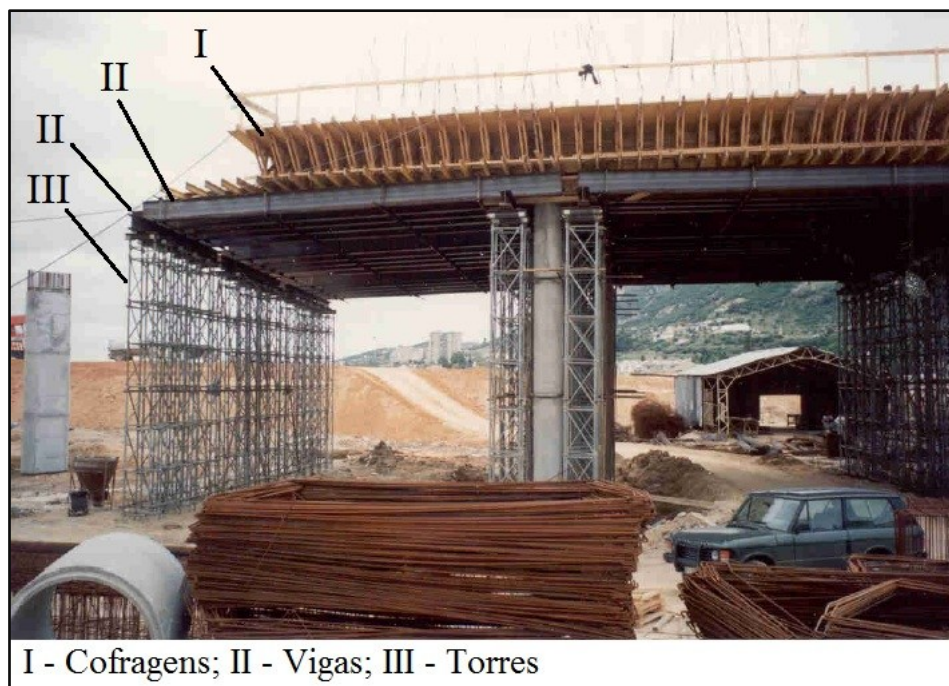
cimbra ao solo constituído por torres e vigas [3]
